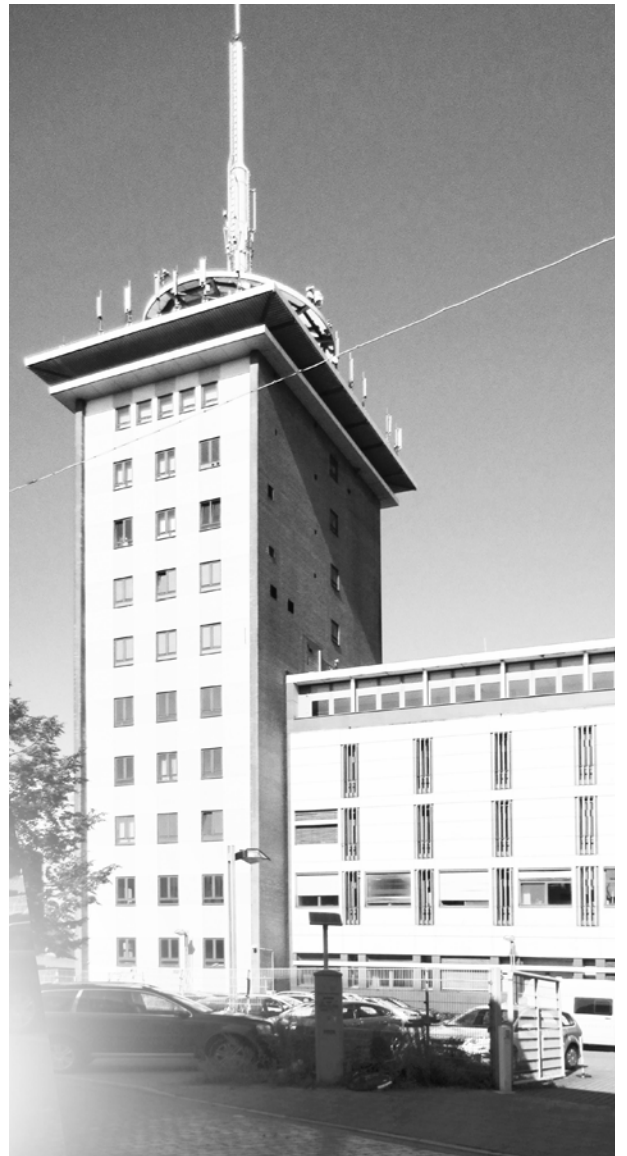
Vorderseite Bestand - Ölmühlenstraße
